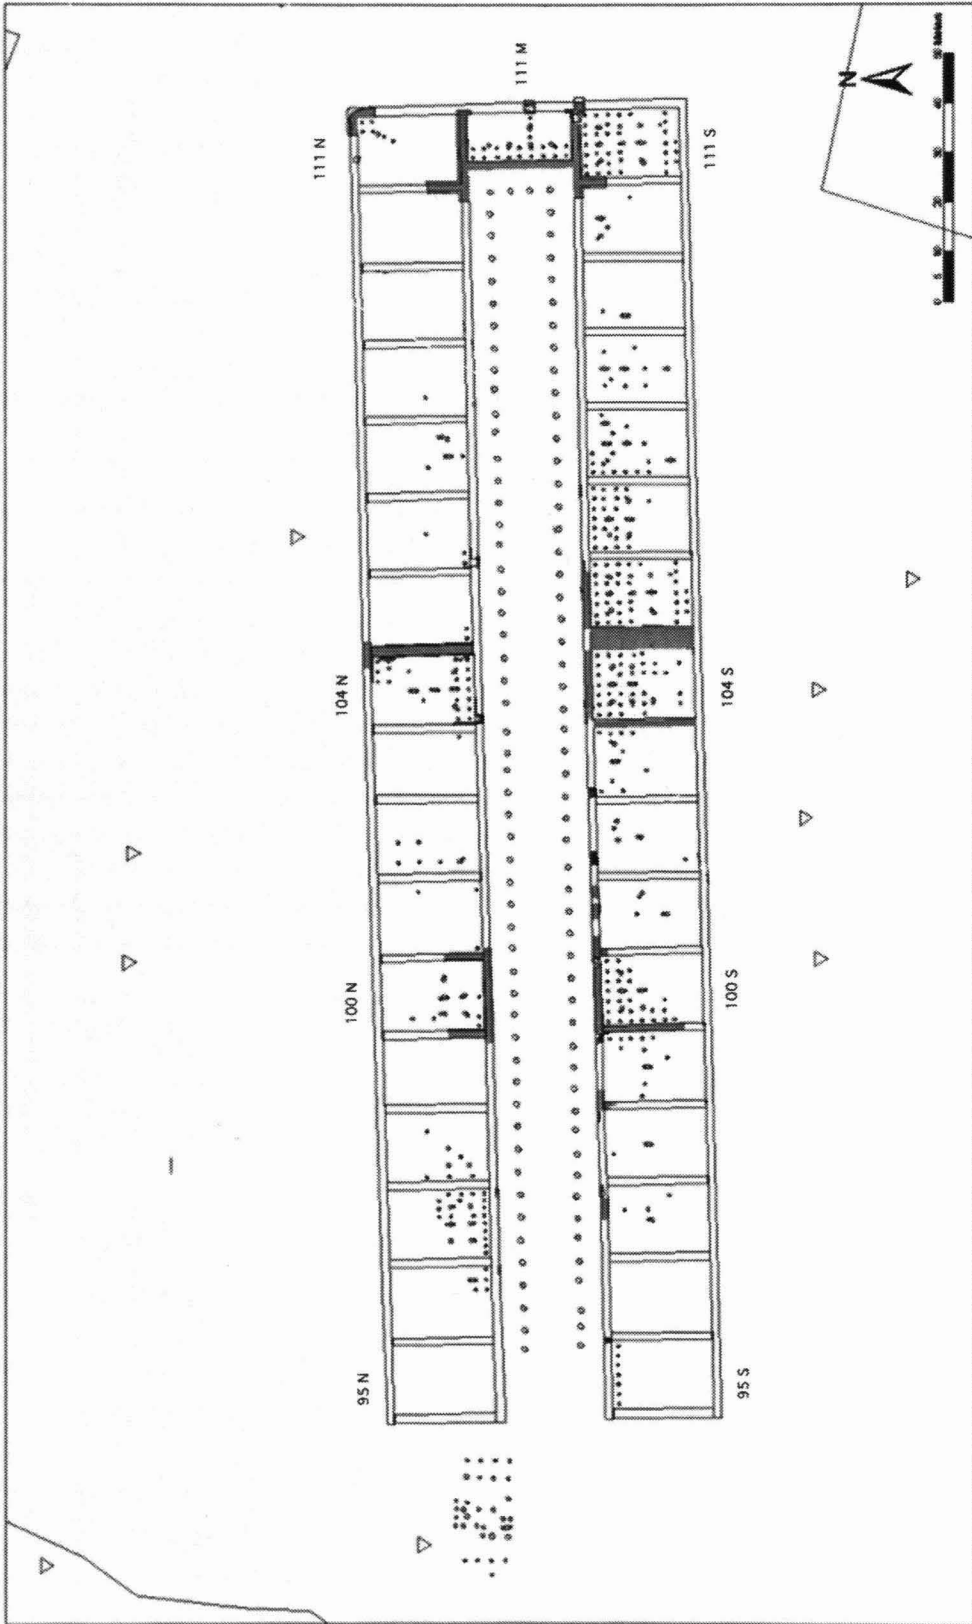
Sanam Abu Dom. Pianta dell'edificio detto “il Tesoro”.
